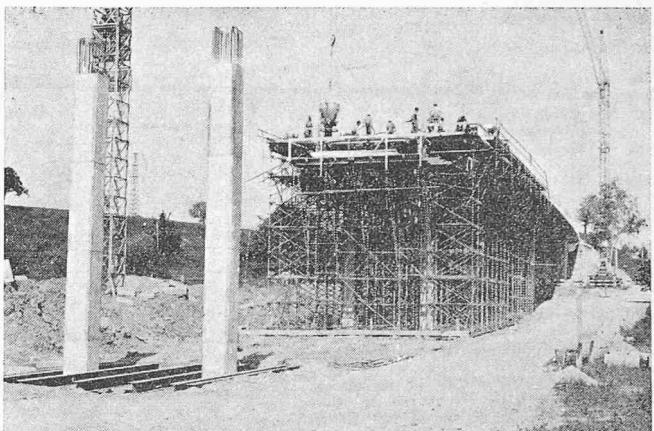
Bauzustand mit dem 18mal wiederverwendeten Stahlrohrgerüst
